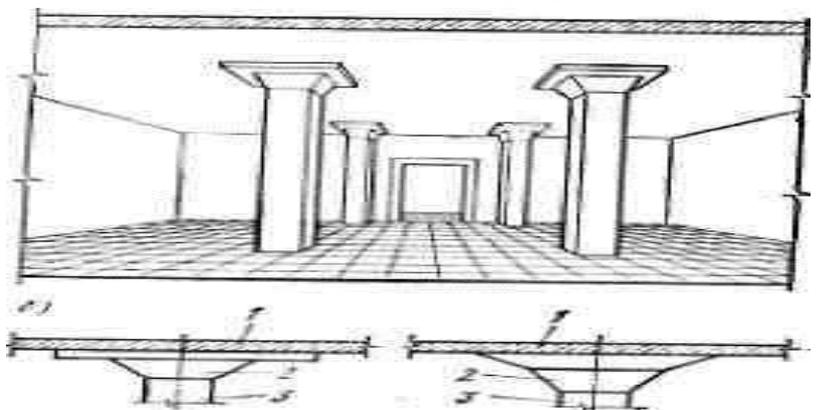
Залізобетонне монолітне без балкове переkritтя:
